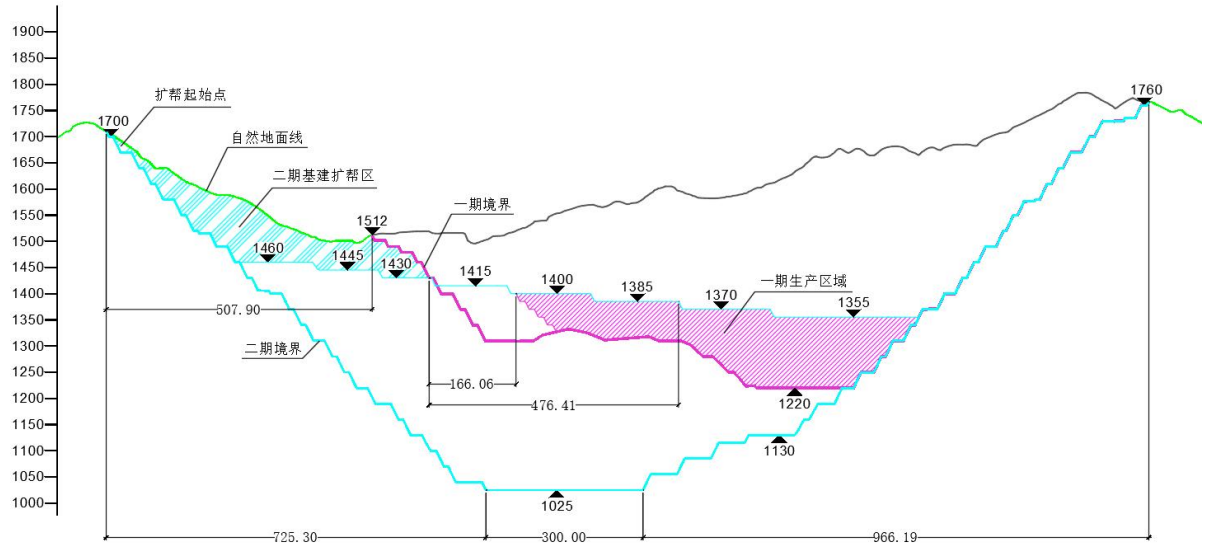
一期、二期露天开采衔接剖面示意图
